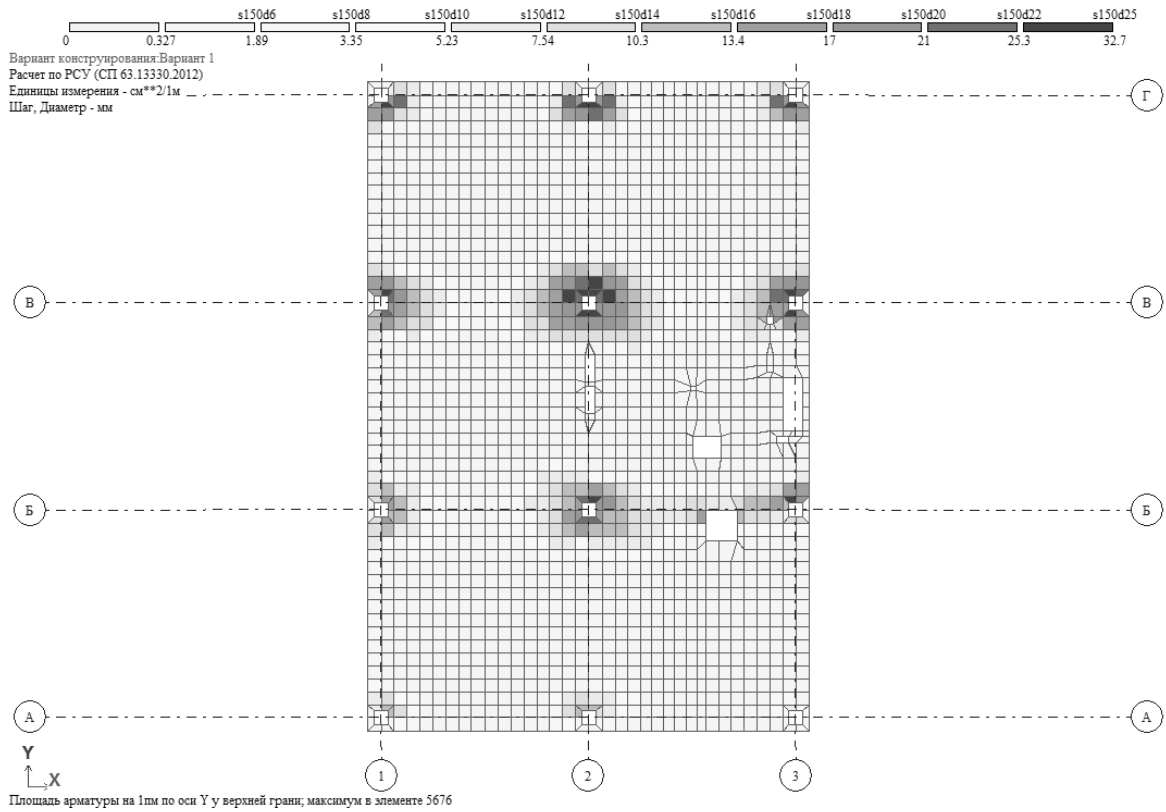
Армирование плит покрытия по оси Y у верхней грани
